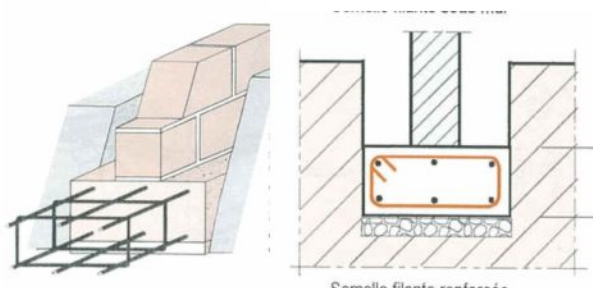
semelle continue renforcée à 2 nappes d'acier filantes
